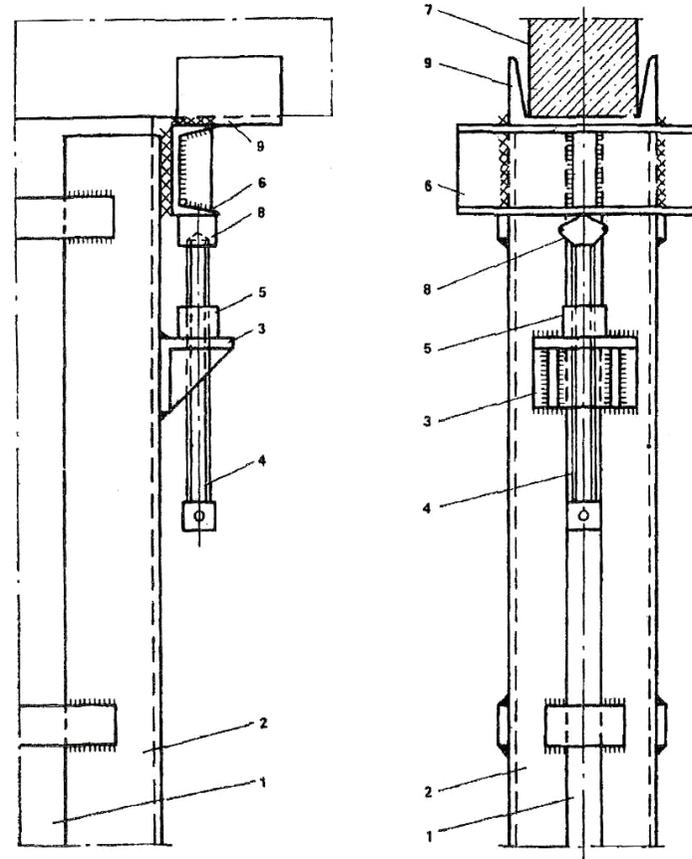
Приспособление для включения в работу металлической обоймы колонны:
